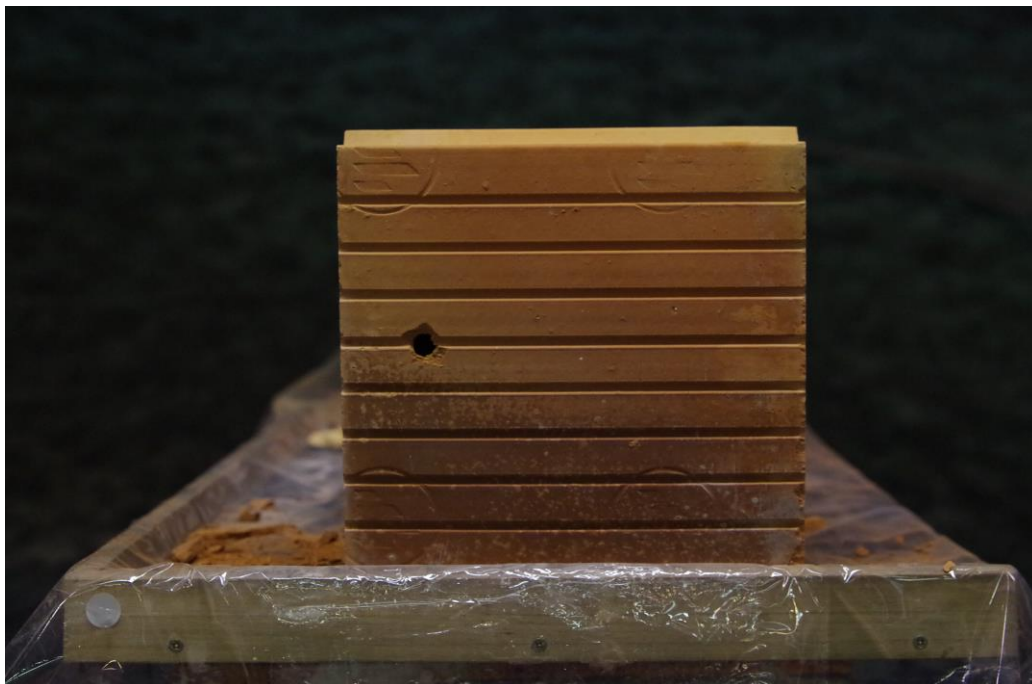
Destrukce střely během testu [Vlastní zdroj]
